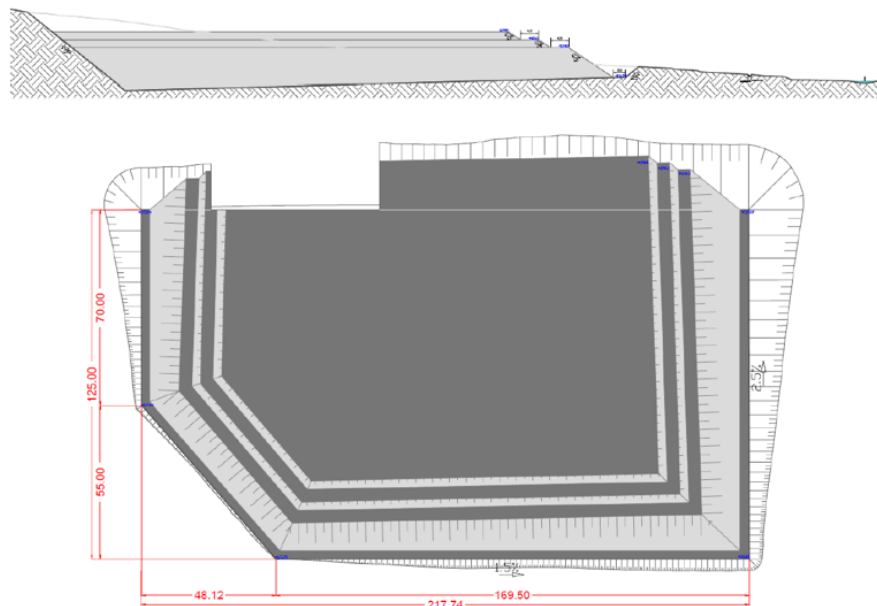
Perfil longitudinal e vista de planta da Instalação Temporária de Resíduos Inertes (ITRI), à escala 1:750. Fonte: RS do EIA
